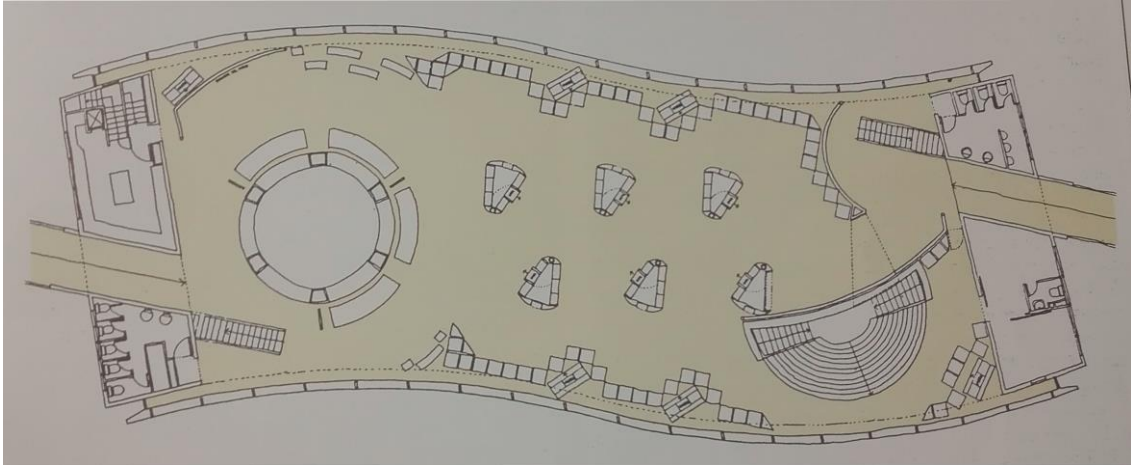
Plano de la planta del primer piso del pabellón chileno.
